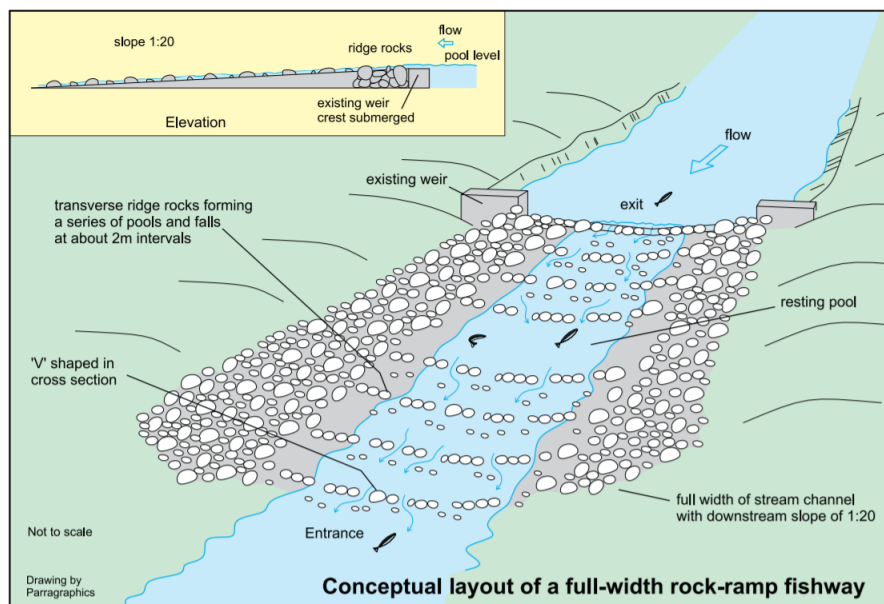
Rampa de roca de ancho completo planeado para el proyecto Miel II, 2017
